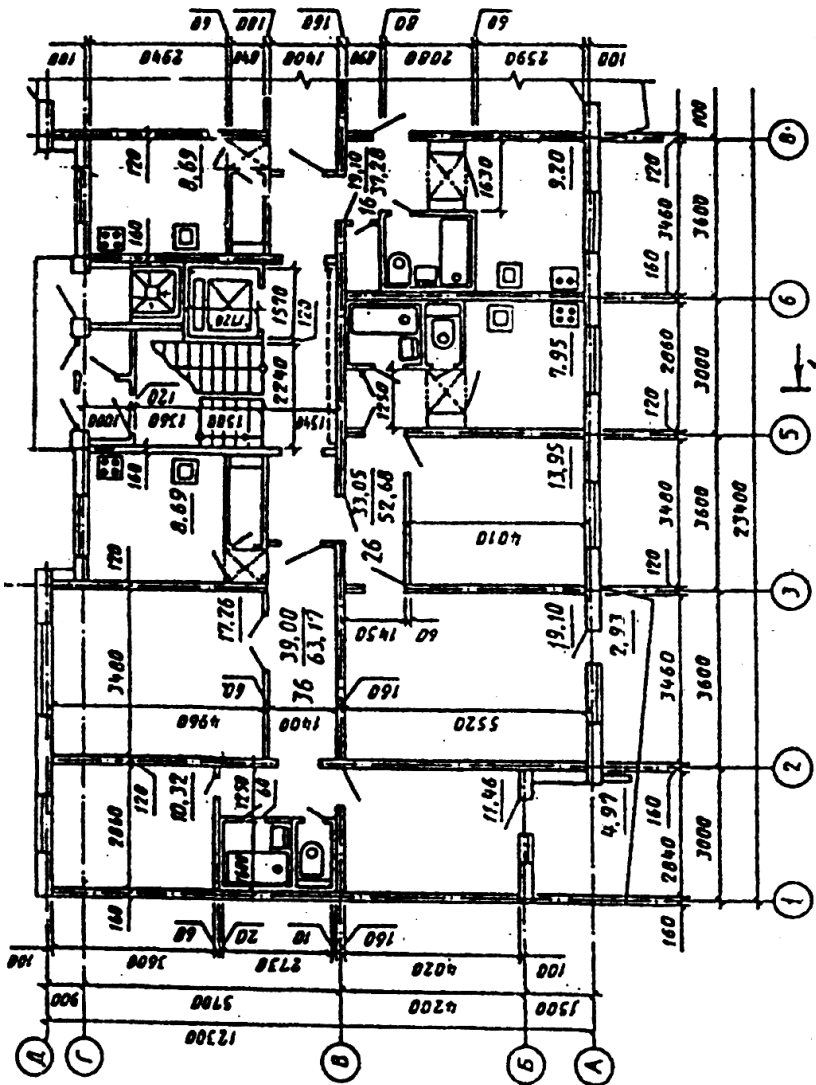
Стандартне виконання креслення плану першого поверху багатоповислової великопанельної житлової будівлі (креслення повернуто)
